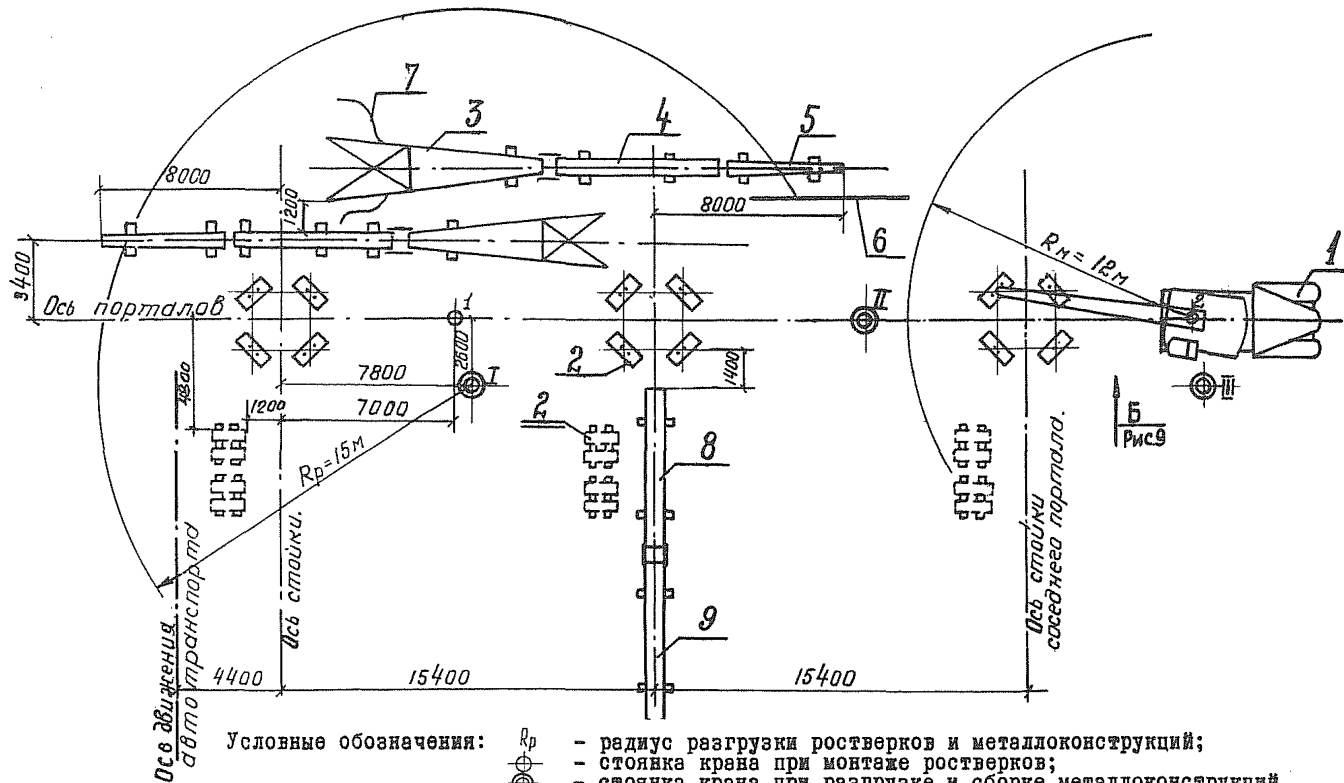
Схема монтажа ростверков и сборки металлоконструкций:
